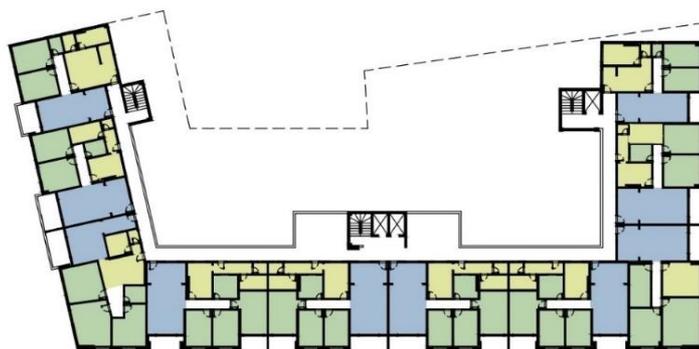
Planta de apartamentos do Edifício Importadora.
